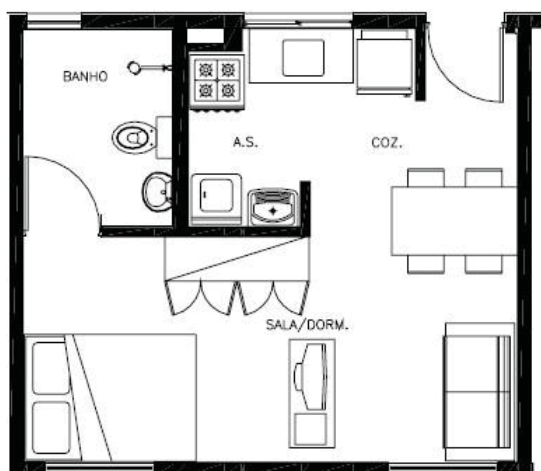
Planta baixa – Kitinete – Conj. Parque do Gato
